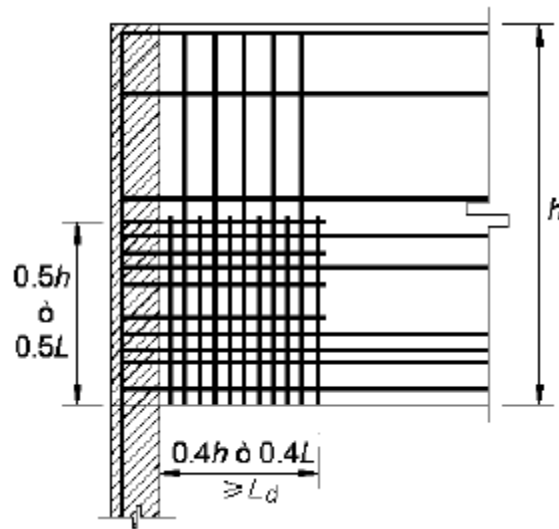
Refuerzo en una zona de apoyo indirecto
